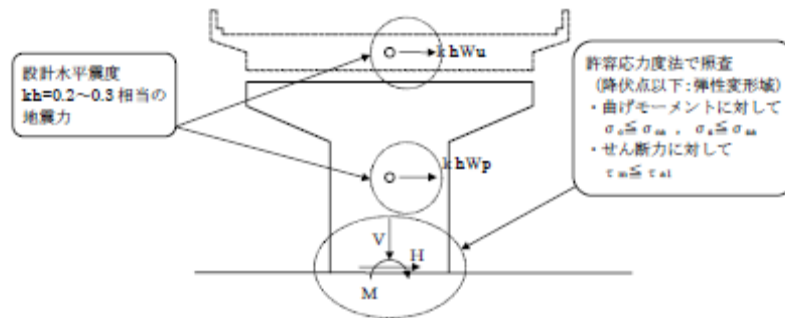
レベル 1 地震動による耐震性能 1 照査の概念
